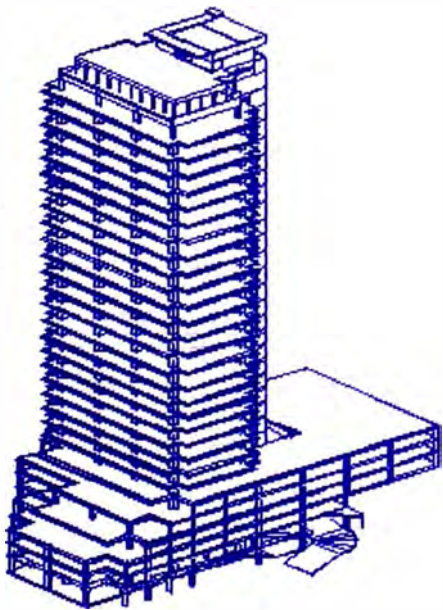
Estructura del Suárez Trade Building (Ref.20)
